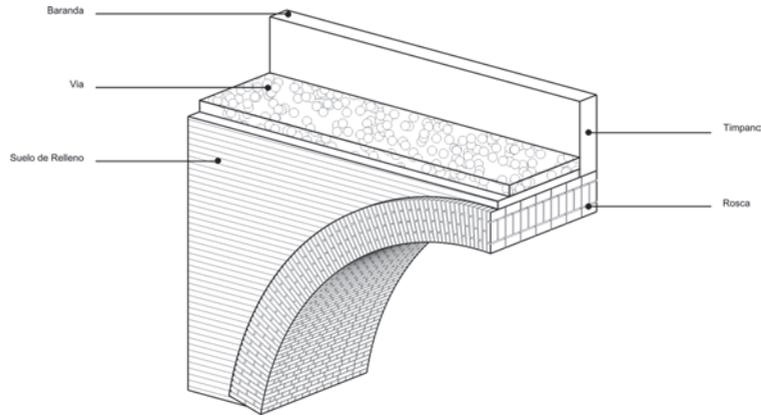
Sección típica de un puente de arco de ladrillo.
